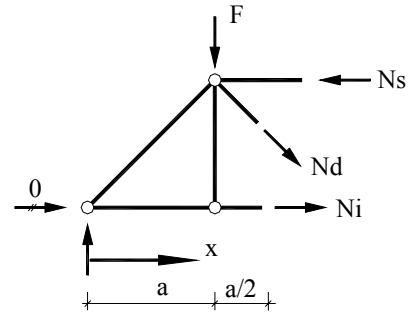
Corte transversal em treliça para a posição 1,5a.
